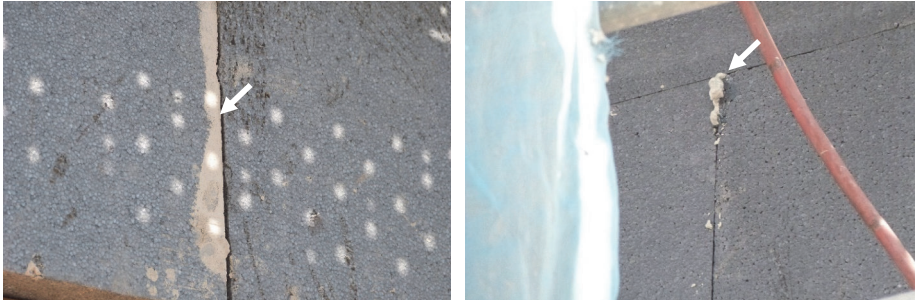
Aislamiento con junta abierta y presencia de mortero.
